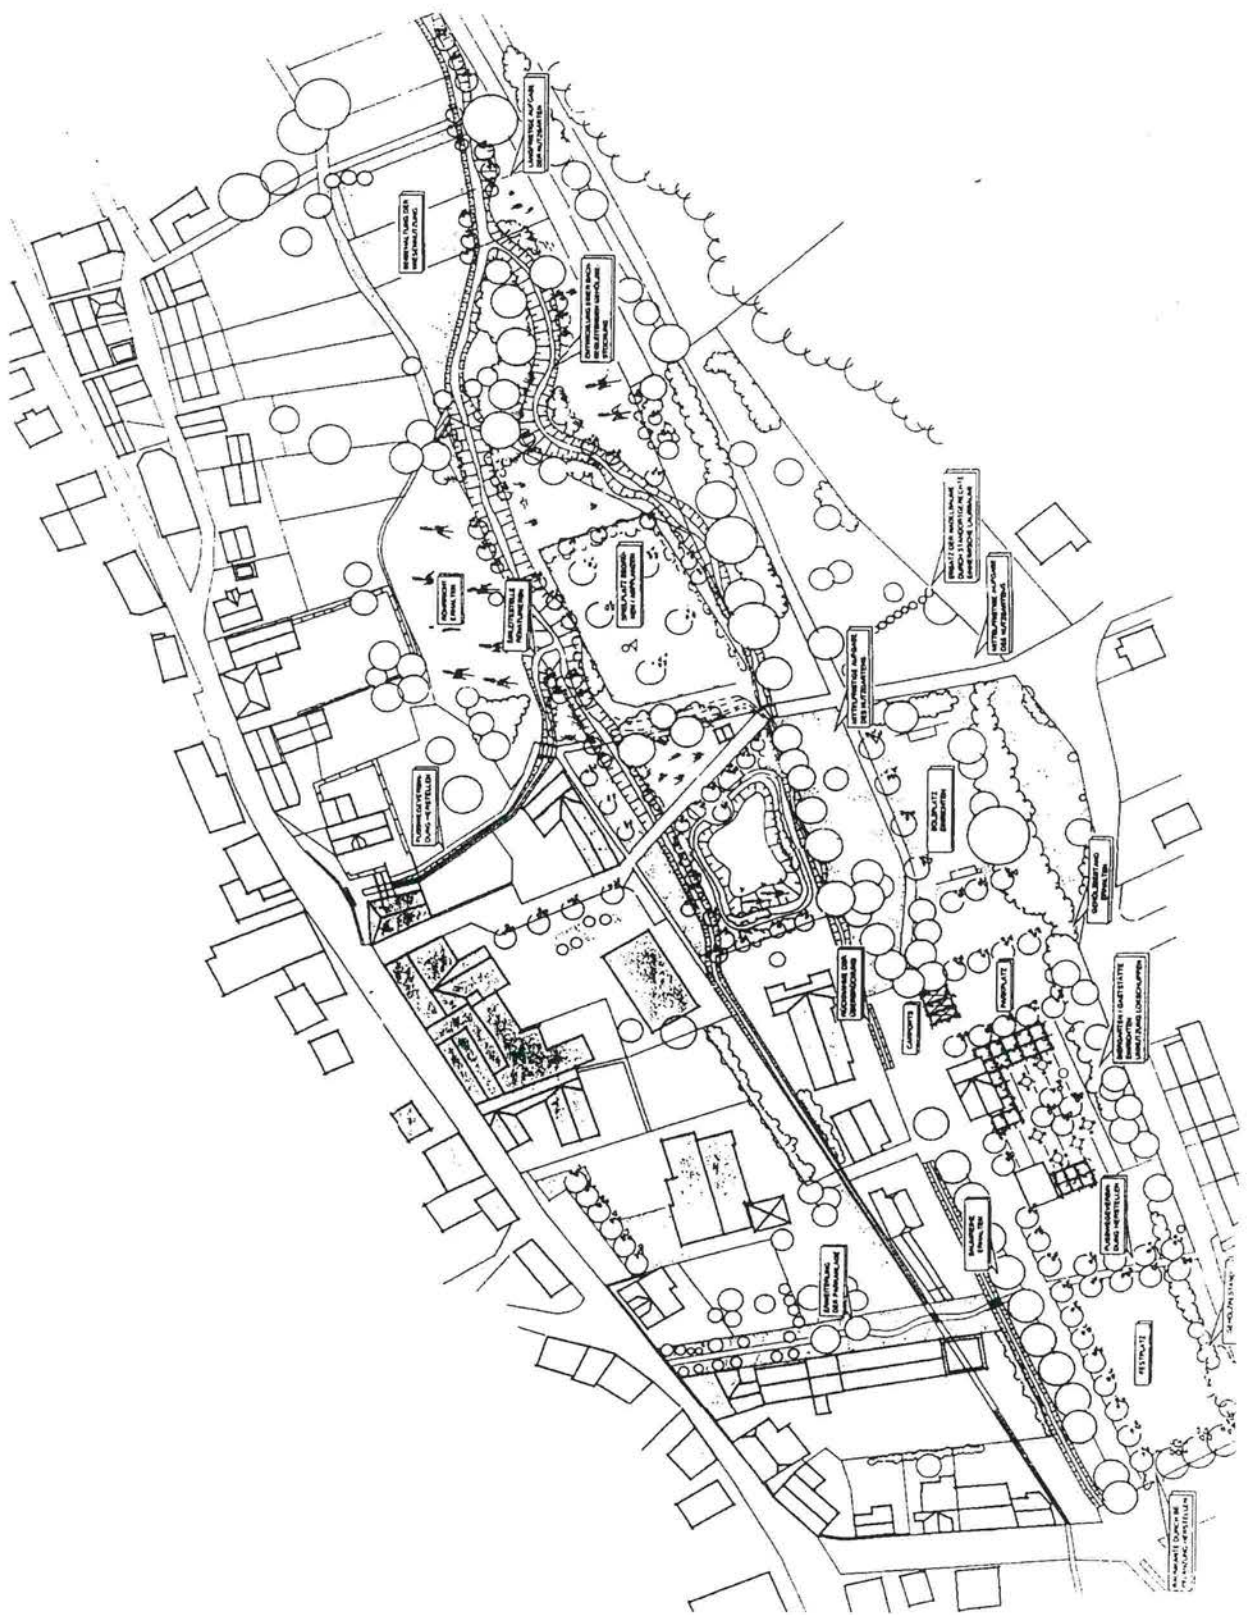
Plan Entwicklungskonzept - Grünordnungsplan
